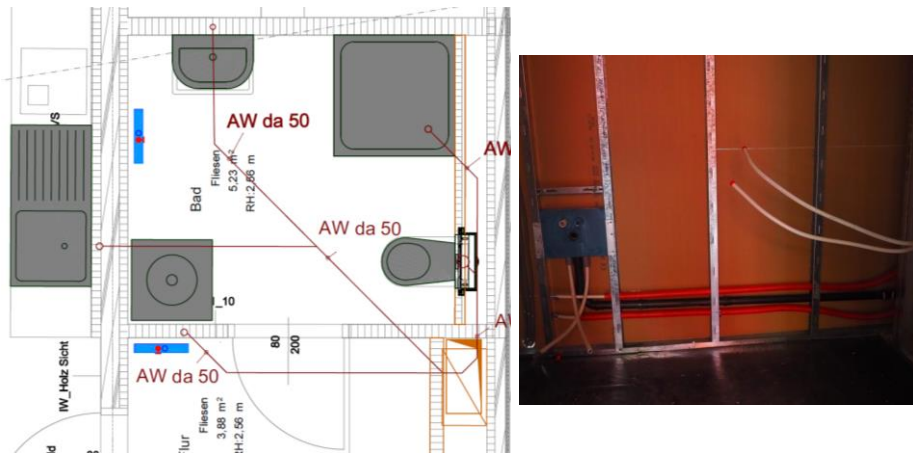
Führung der Abwasserleitung des Waschtisches laut Plan (links) und tatsächliche Ausführung (rechts)
